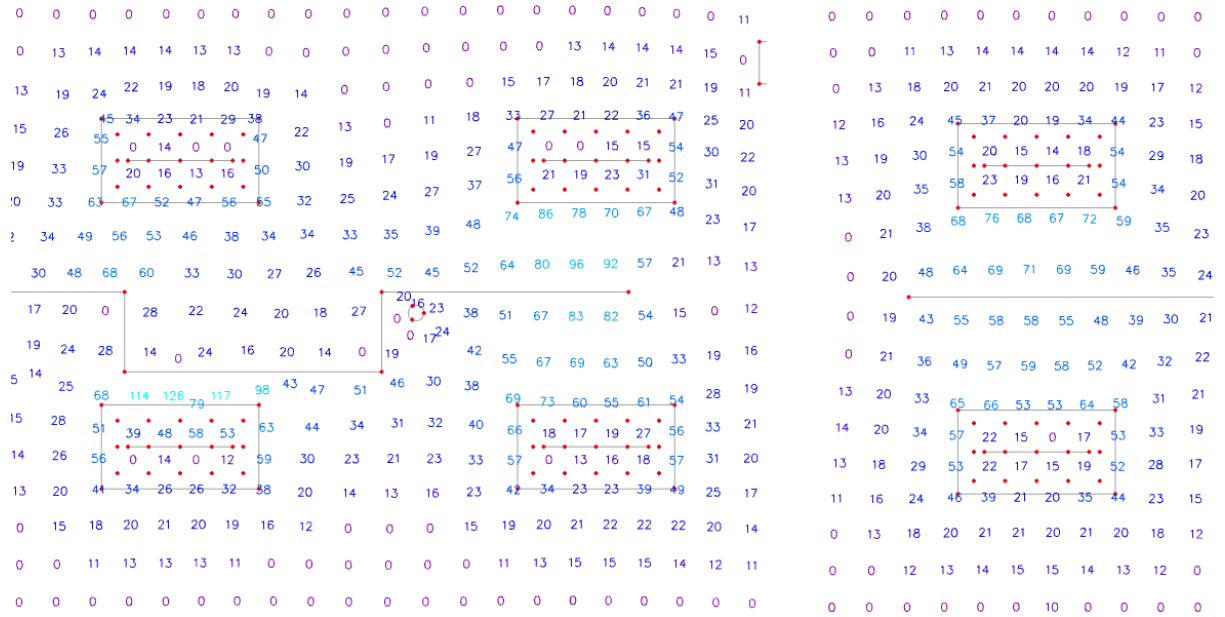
Nutná horní výztuž ve směru Y rovnoběžném s osou trámu [cm²/m]
